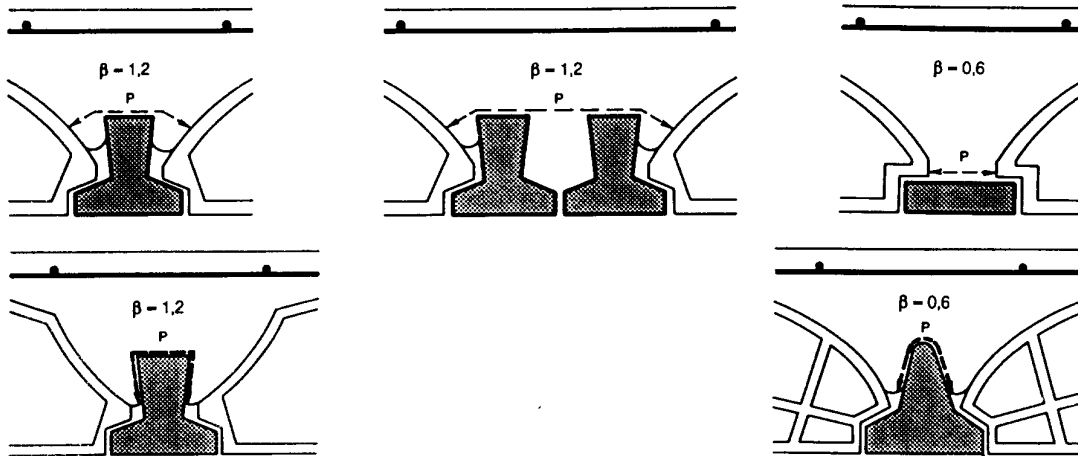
Comprobación a rasante en el perímetro de contacto entre hormigones.
